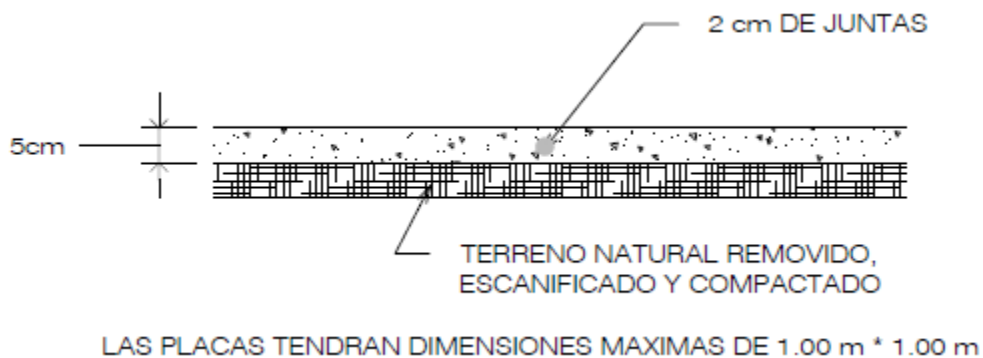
Detalle de superficie de rodadura de concreto en placas prefabricadas.
